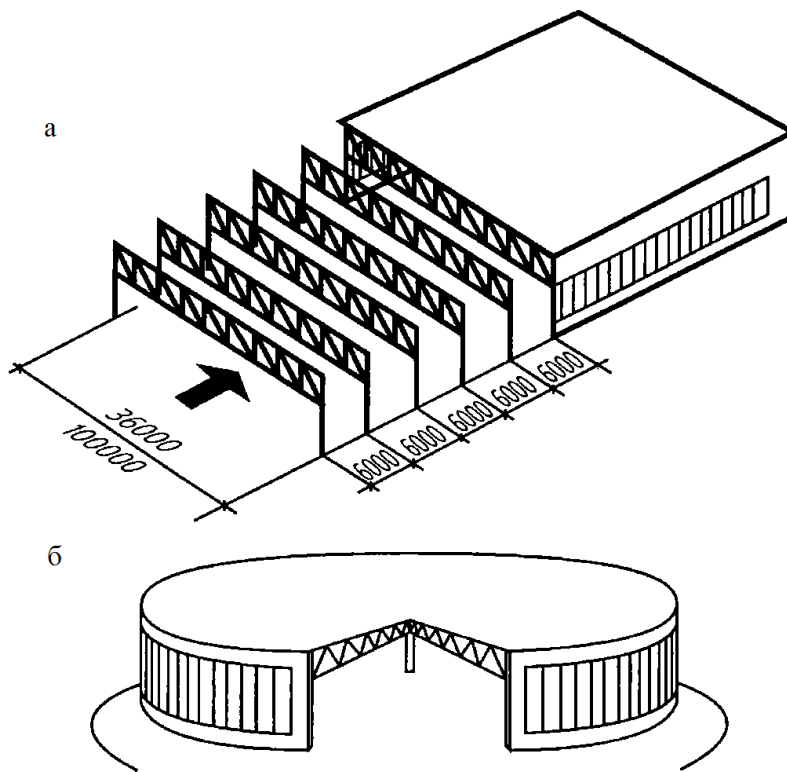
Промислові будівлі зального типу: а – без проміжних опор; б – з центральною проміжною опорою
